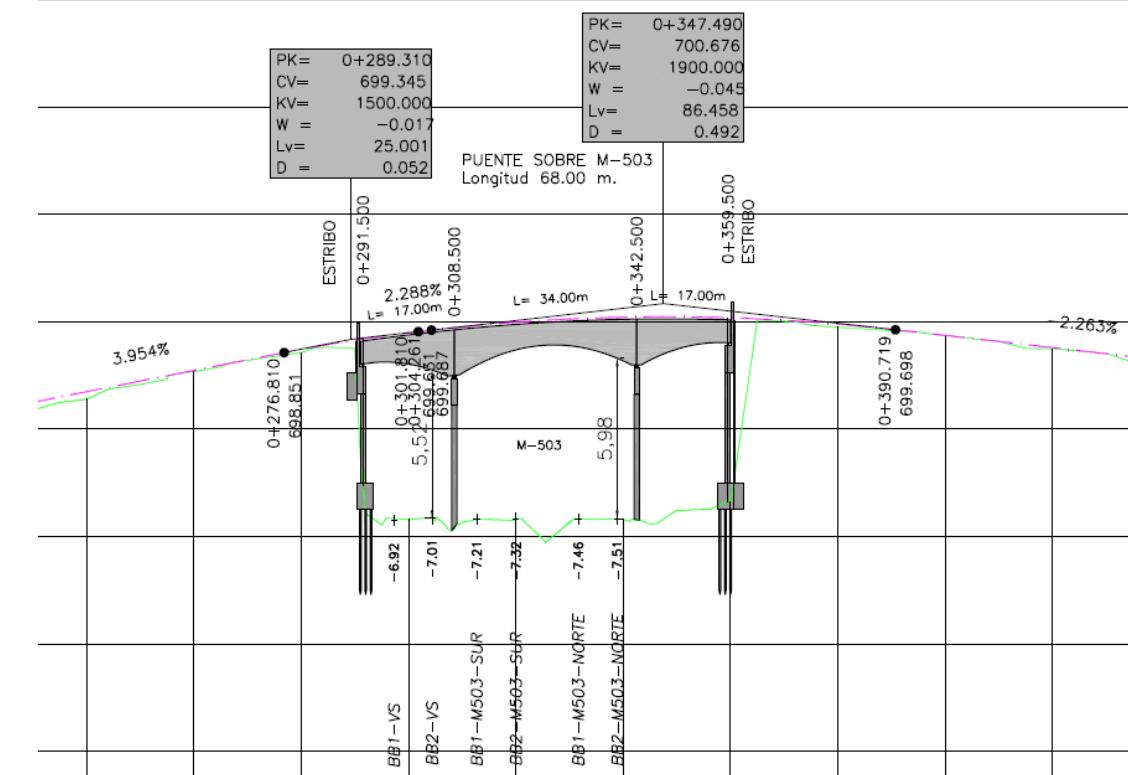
Perfil longitudinal ESTRUCTURA 4
